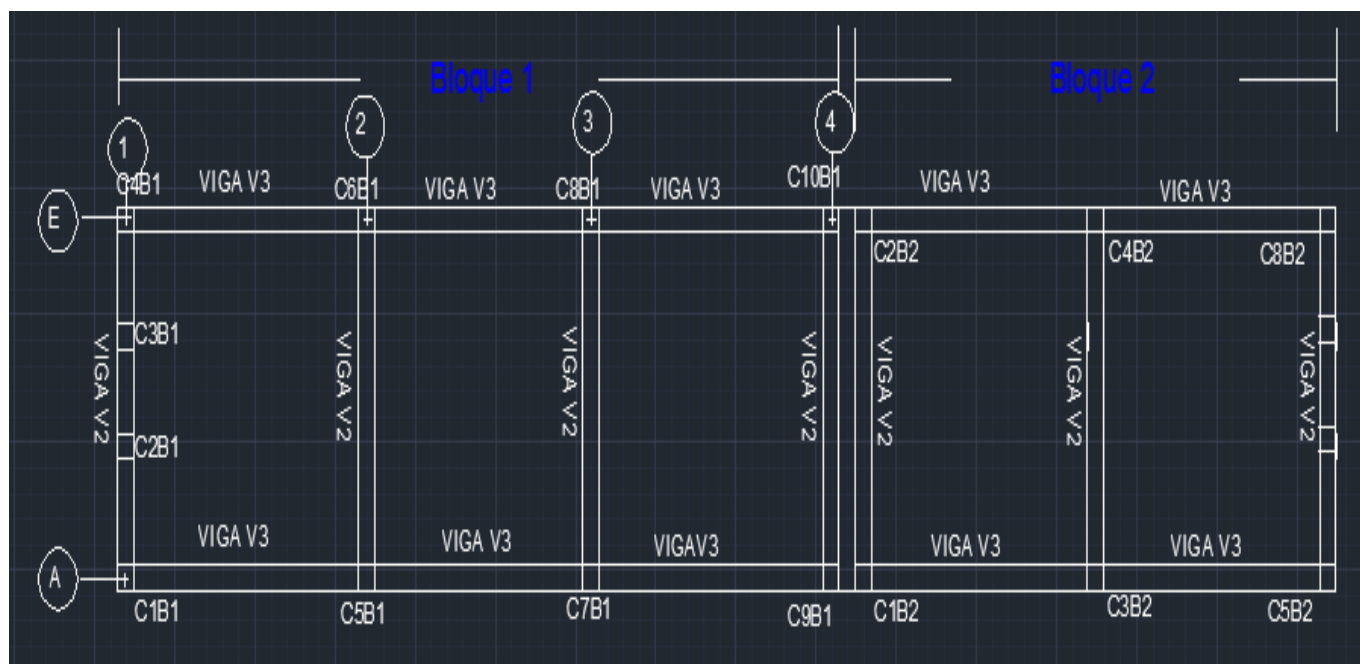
Distribución de vigas y columnas de la planta alta de los bloques 1 y 2
